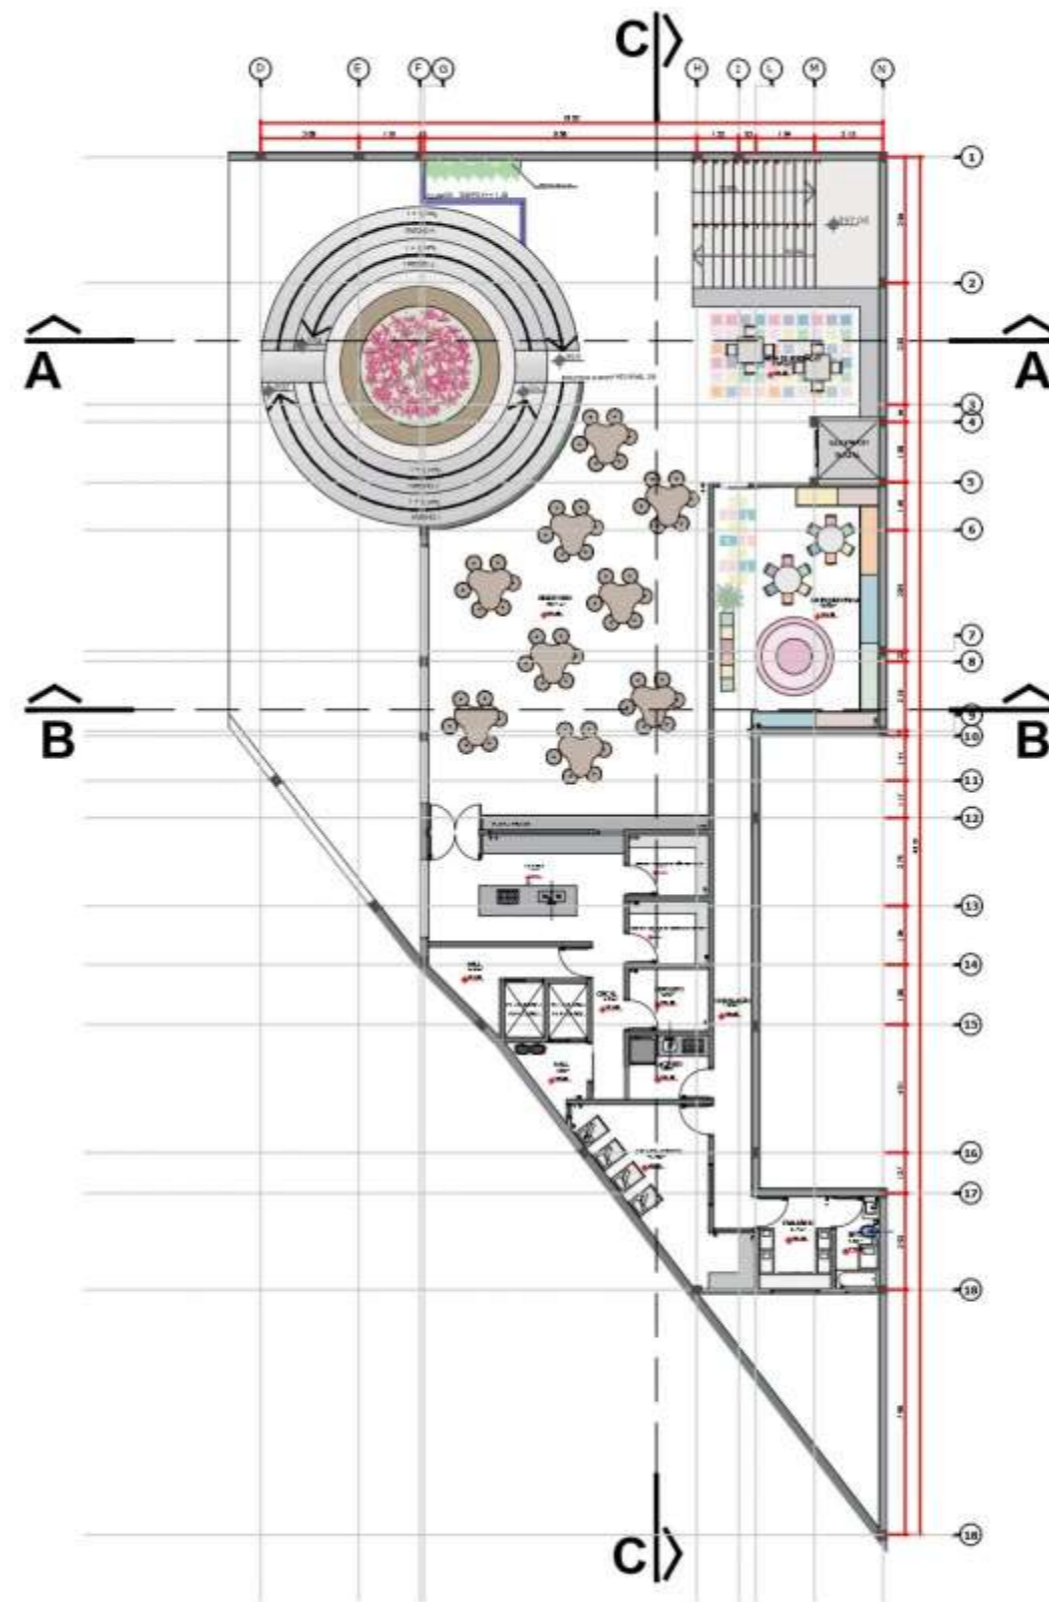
Pavimento subsolo – nível 590,00 e Pavimento Térreo – nível 591,00
